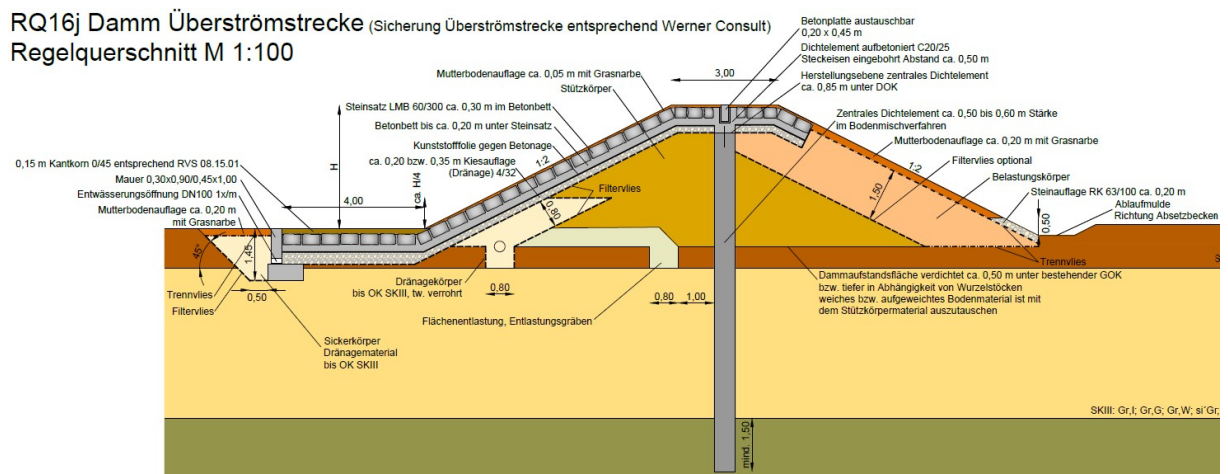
Überströmstrecke im Dammbereich – Becken 2 (Nordwest) ([17], Beilage 7)
